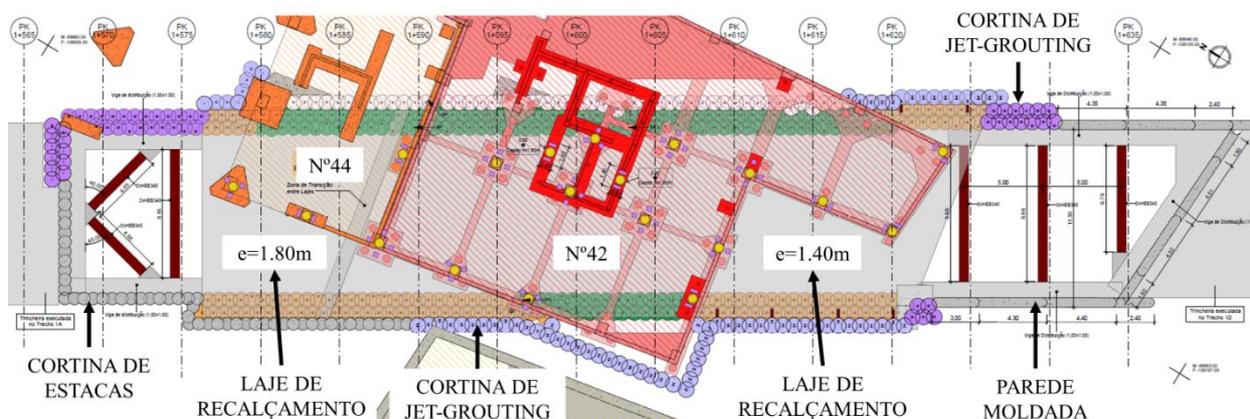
Vista em planta: Solução de escavação e escoramento Cut & Cover.
